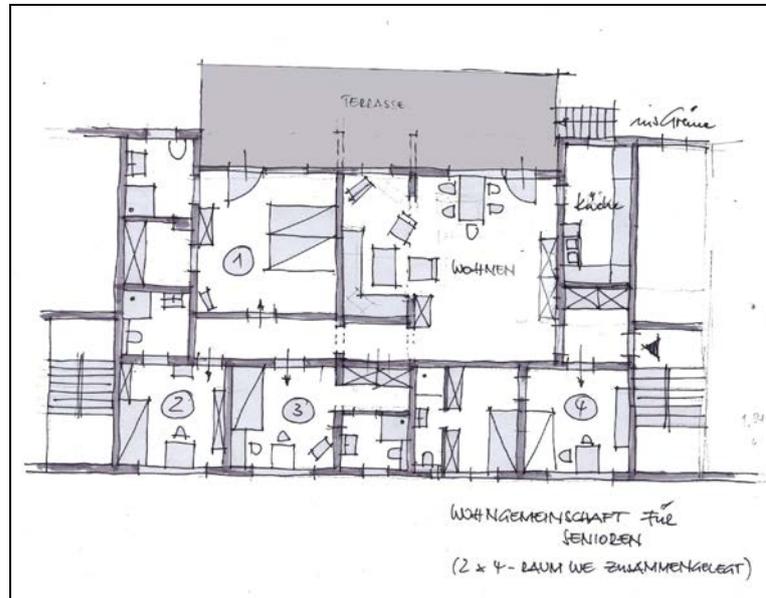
Beispielgrundriss für Seniorenwohngemeinschaft
